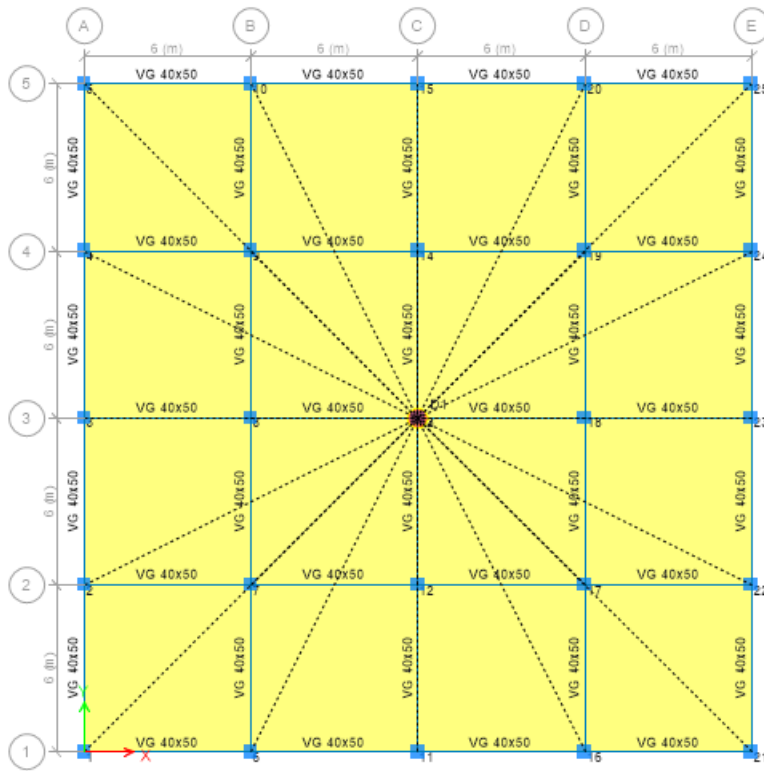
Planta Edificación en base fija Modelo Matemático. Fuente: Propia
